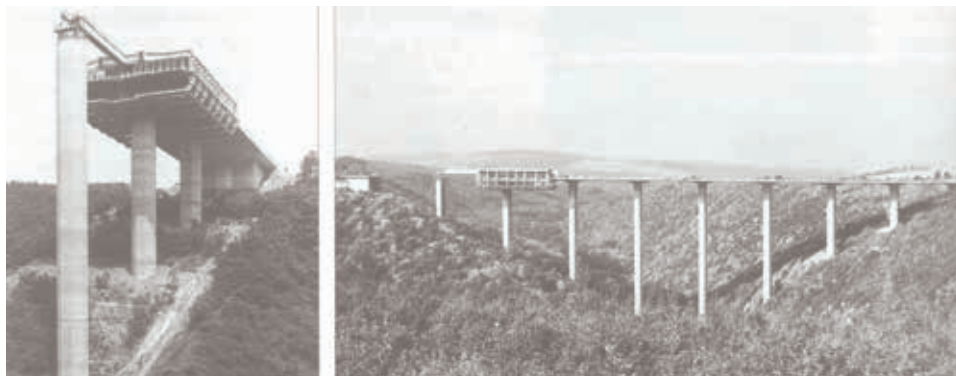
Viaducto de Elztal (Alemania) de Ulrich Finsterwalder 37,5 m de luz. Tablero tipo losa postesada de sección variable. 1966
